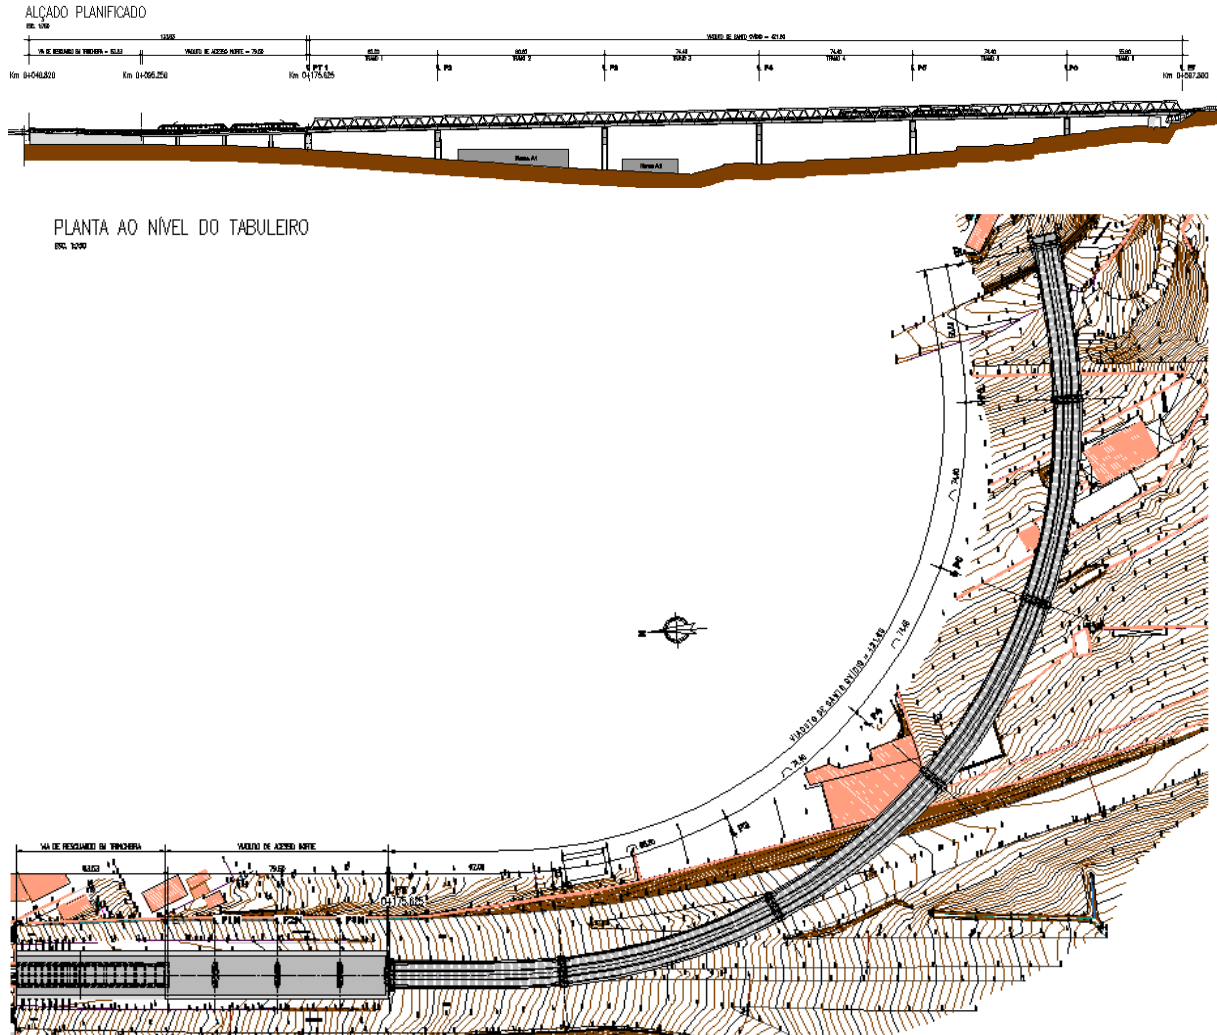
Planta do conjunto e alçado geral das obras-de-arte
